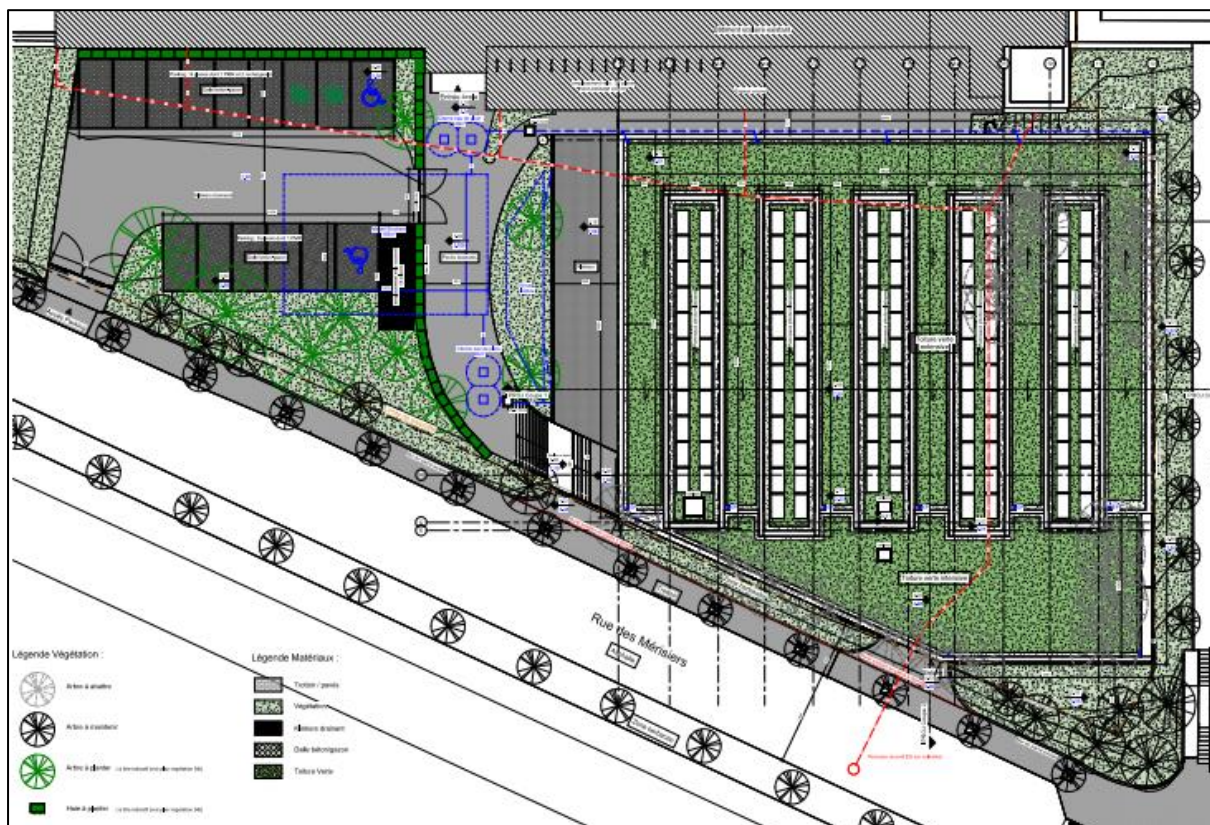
Plan d'implantation – situation projetée (Source : [REDACTED])
